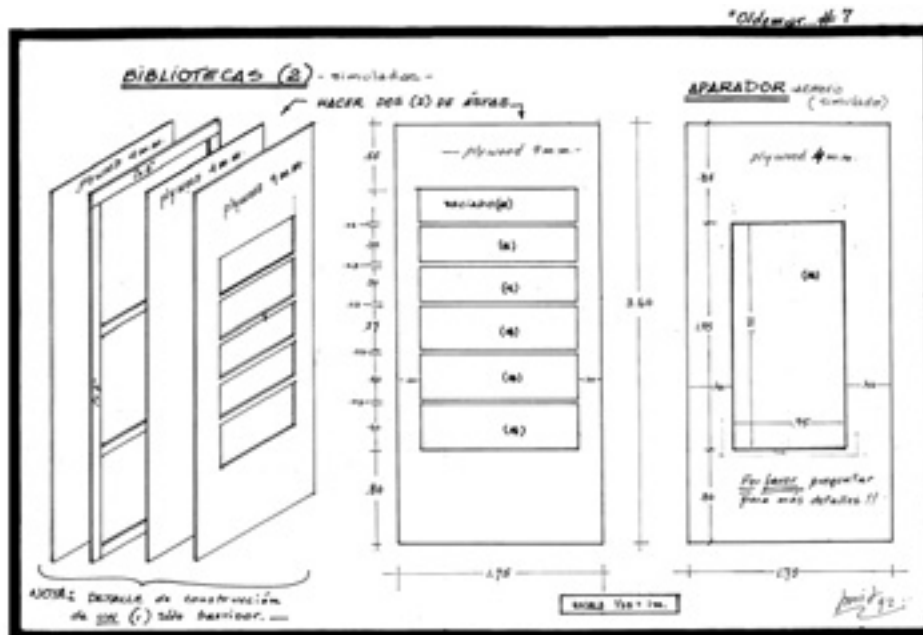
Detalle de la construcción de los paneles que van tapando las puertas.
